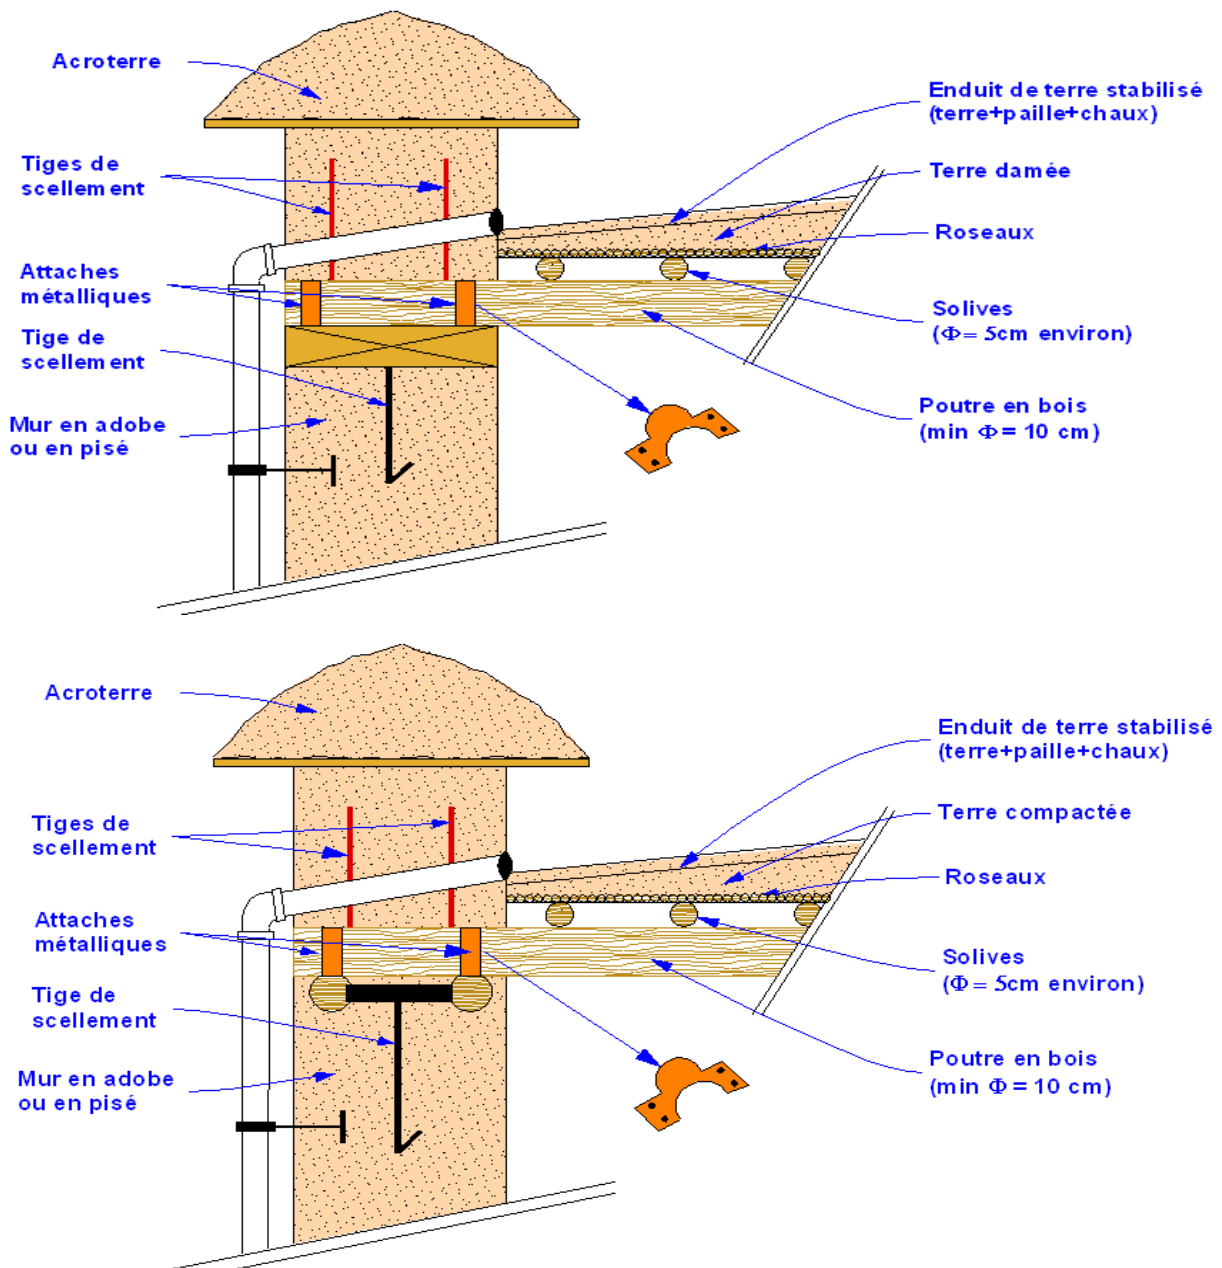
Chaînage horizontal en bois ; Toiture traditionnelle et attaches mur-chaînage et plancher-chaînage
